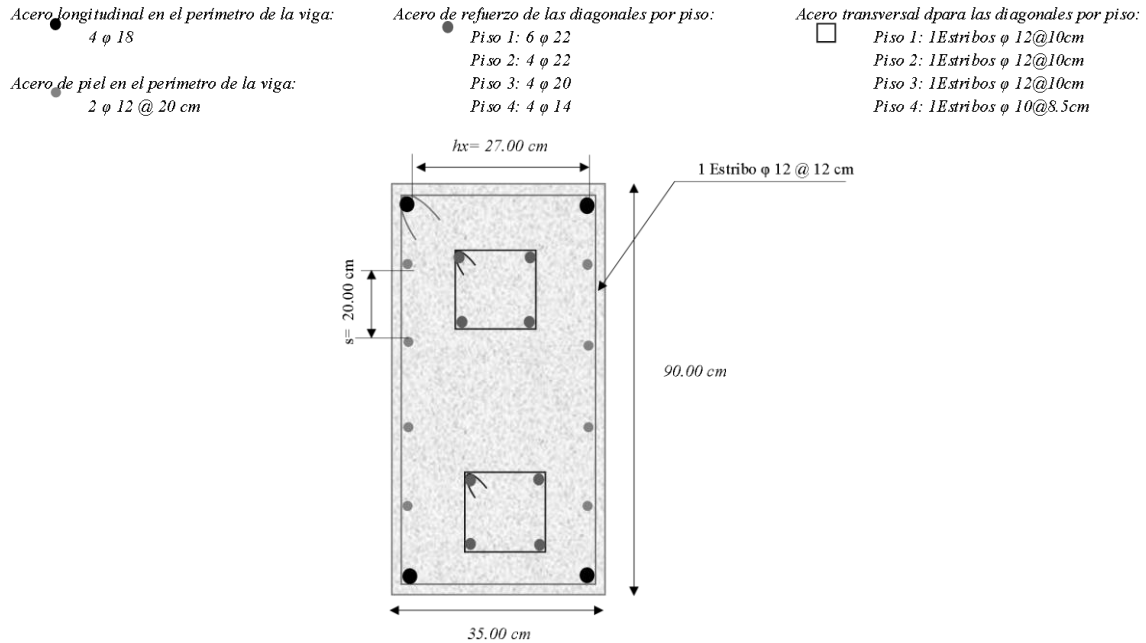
Armado de las vigas de acople de la geometría 1 en base al FBD
